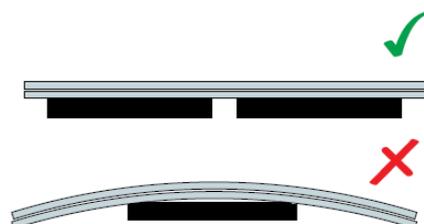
Maderas colocadas en el piso. Fuente: BlueScope
